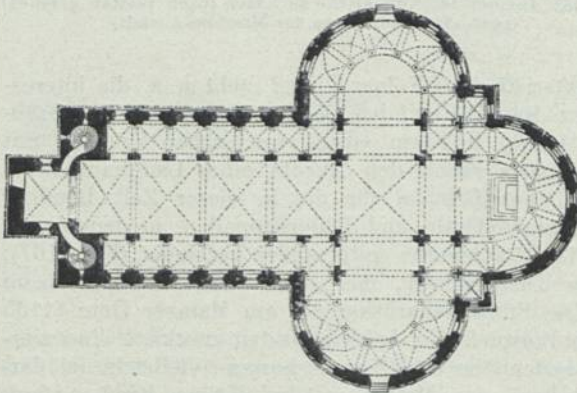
Grundriss von St. Marien auf dem Kapitol zu Köln
